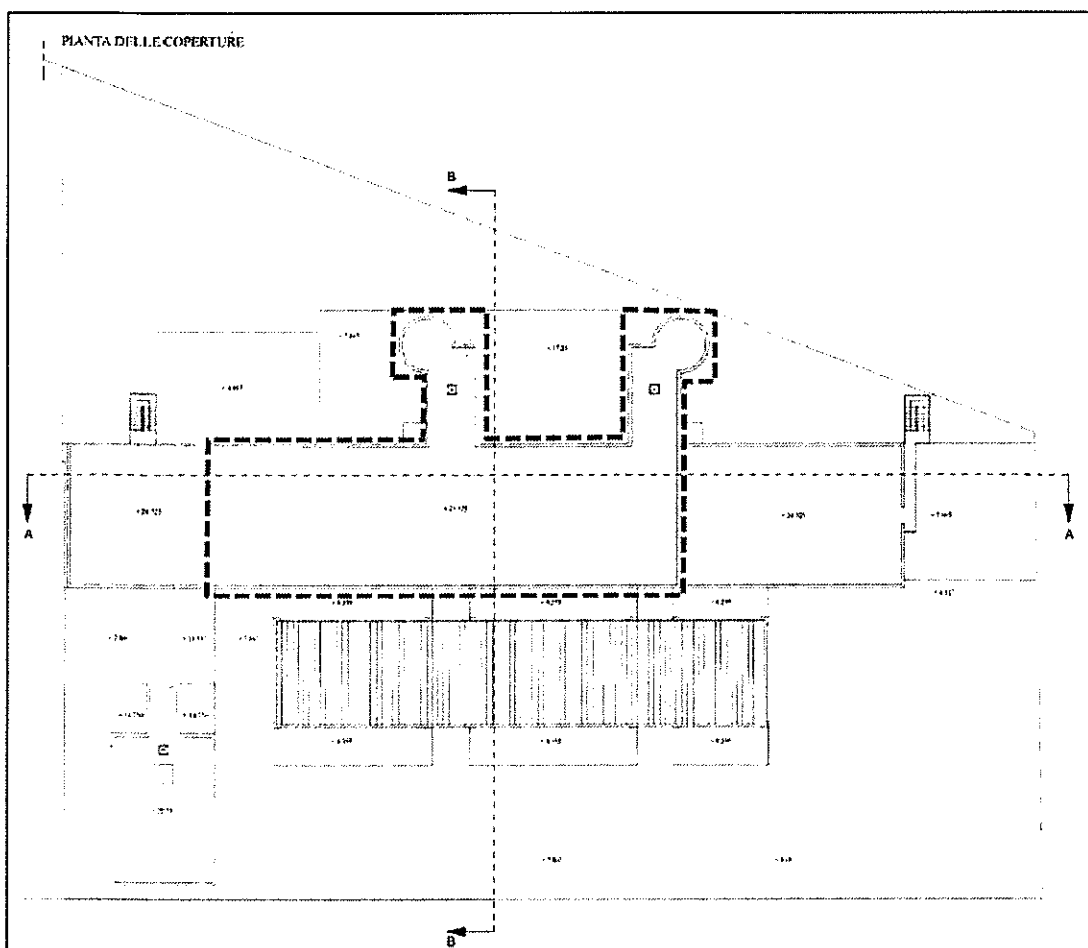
Progetto del piano sesto estratto dalla tavola allegata al PdC n. 59/2013.
